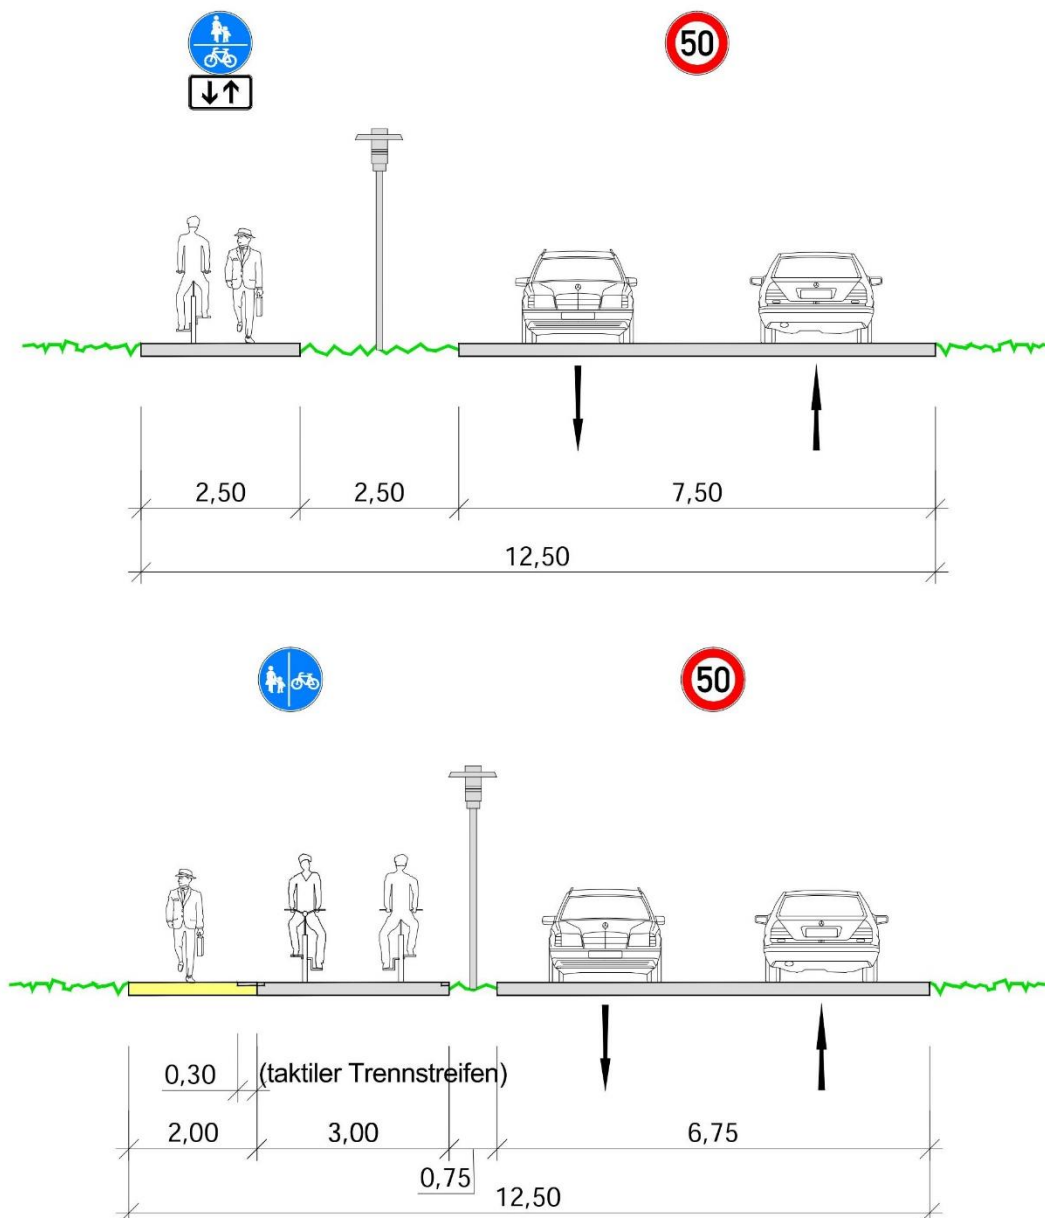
Schleißheimer Straße (TÜV Süd bis Robert-Bosch-Straße) – Bestand (oben) und Planung (unten)
